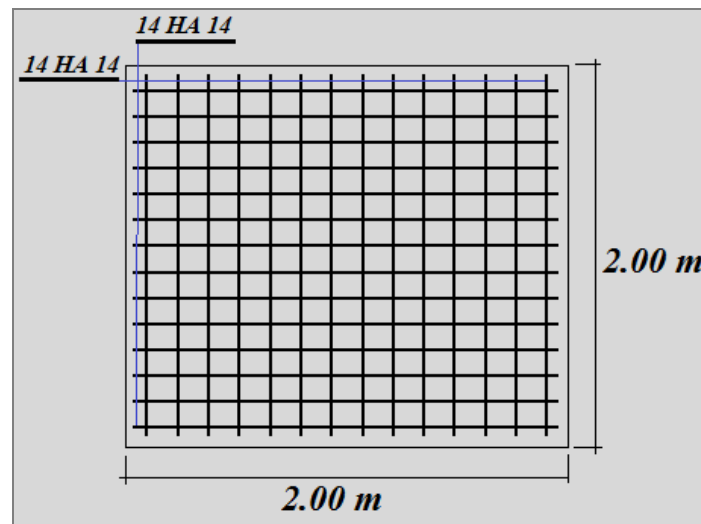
Schéma de ferrailage de semelle isolée.
